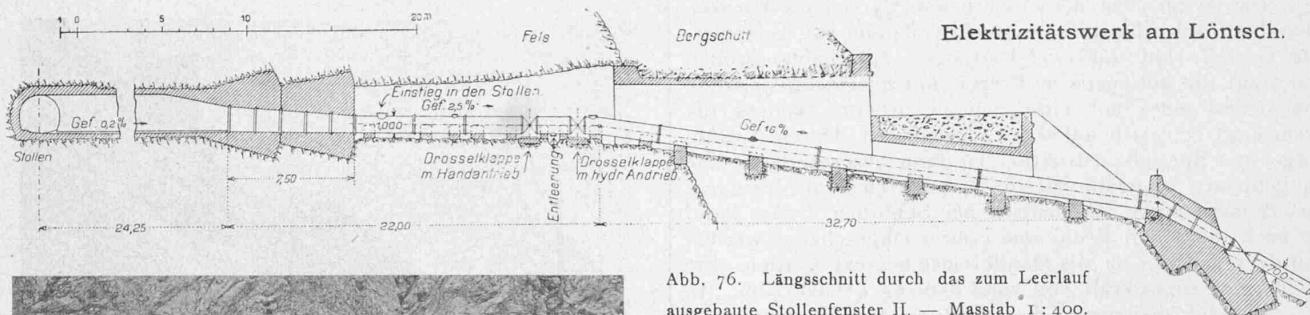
Längsschnitt durch das zum Leerlauf ausgebaute Stollenfenster II. — Maßstab 1:400.
